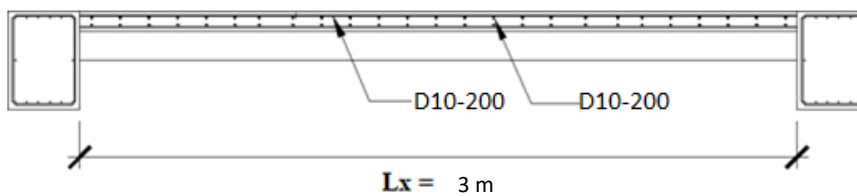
Detail Penampang Tulangan Tumpuan Arah Y Plat Type A2
